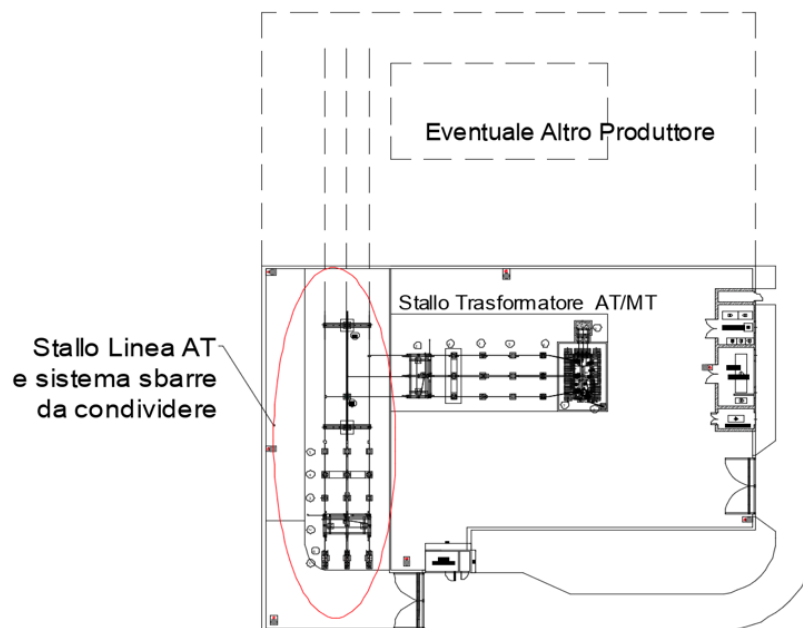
Planimetria Sottostazione di Trasformazione Utente AT/MT
